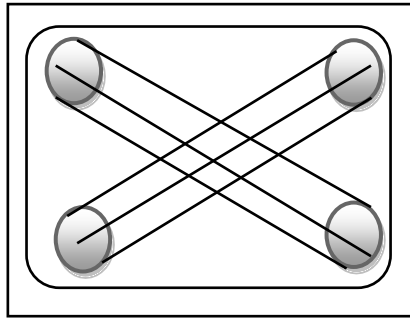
Ferrailage mixte d'une semelle sur quatre pieux.
